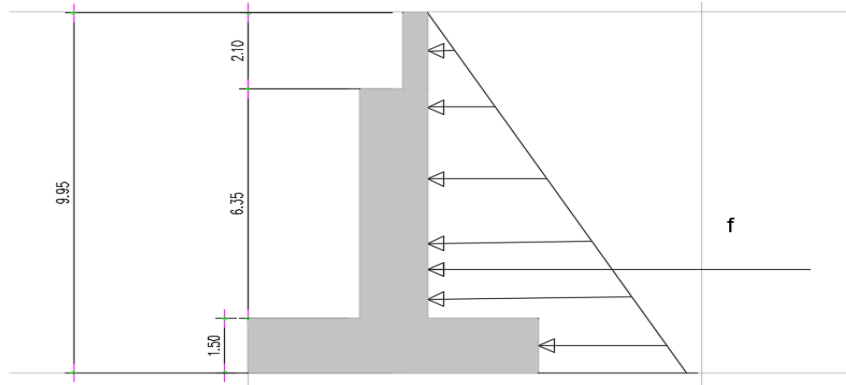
Poussée des terres sur (le mur frontal + mur garde grève et la semelle).
